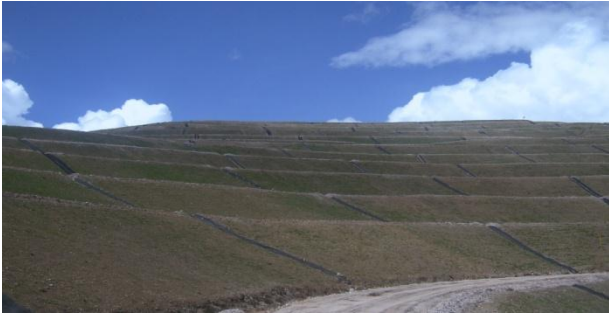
Vista da Pilha de Estéril em processo de restauração, com canais com uso de geotêxtil.
